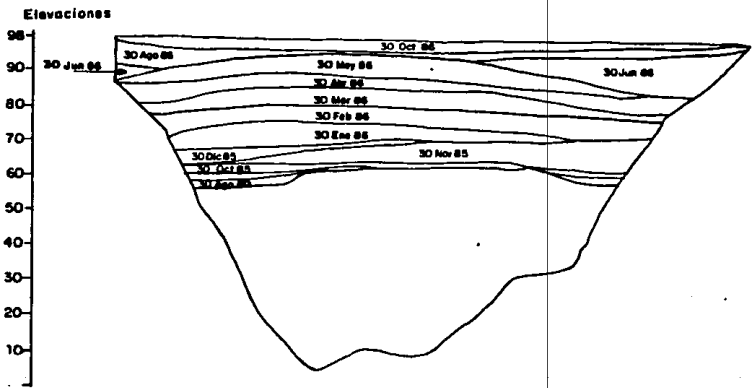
2 Avance de la construcción de la cortina (Corte Longitudinal)
